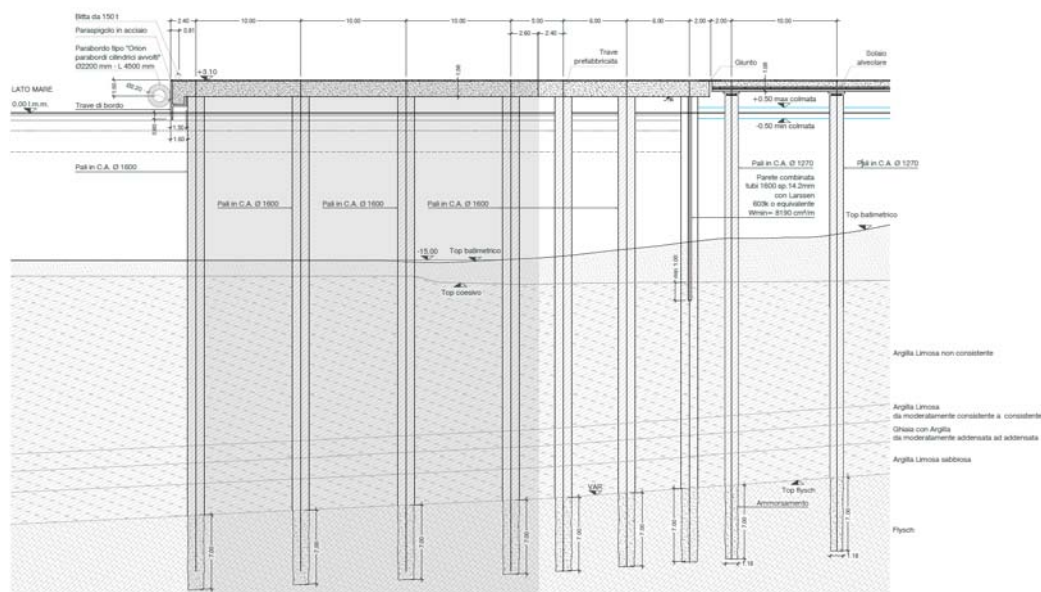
Stralcio della Sezione A-A di progetto (cfr. EG 05)
